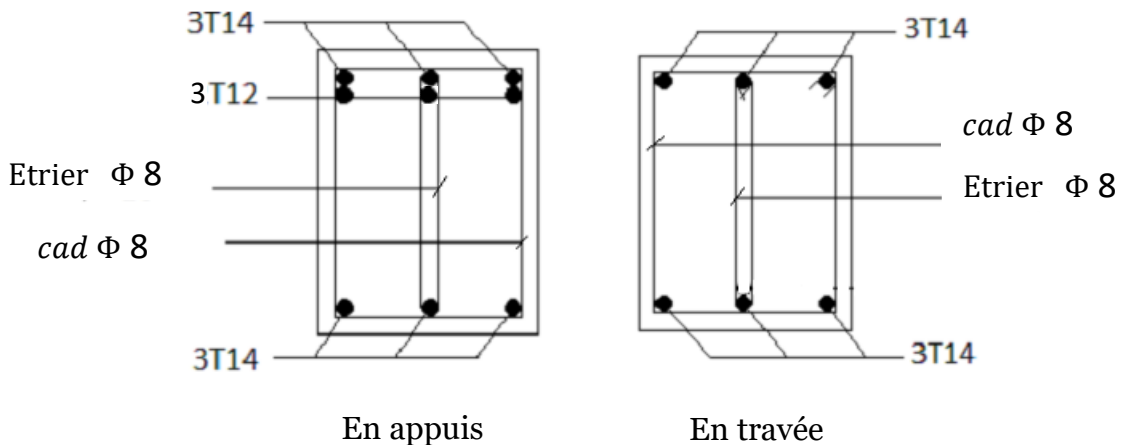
schéma de ferrailage de la poutre secondaire (30 × 35)cm²
